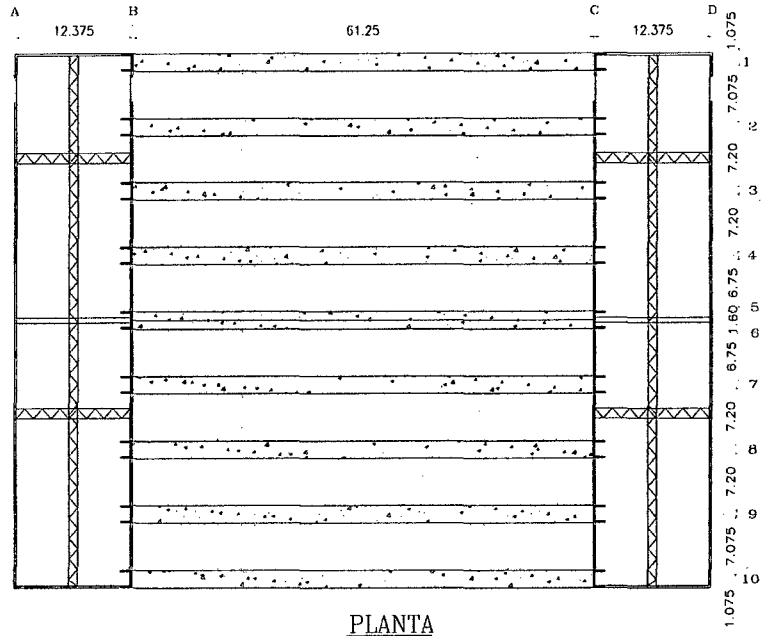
Planta de Hangar en el Aeropuerto del Callao.
